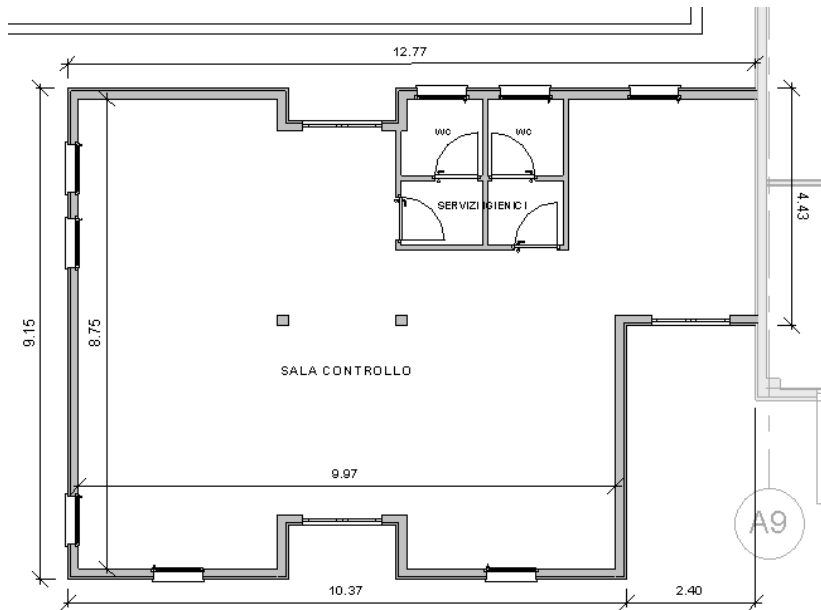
Pianta Edificio Sala controllo – stato di progetto
